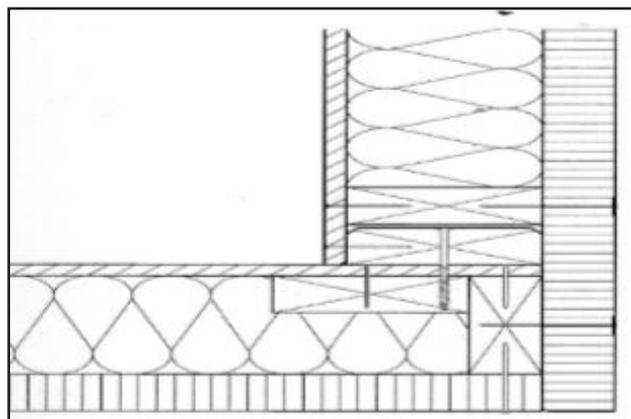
Coupe longitudinale du détail d'assemblage mur extérieur-extérieur.
